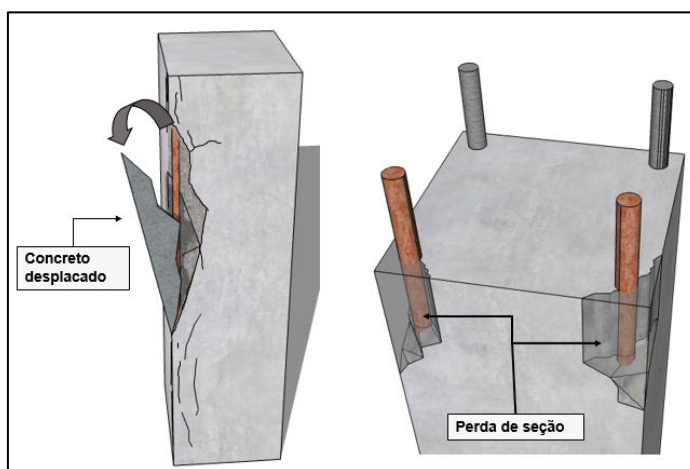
Ilustração do processo de corrosão, perda da seção das armaduras e consequente deslocamento do concreto
